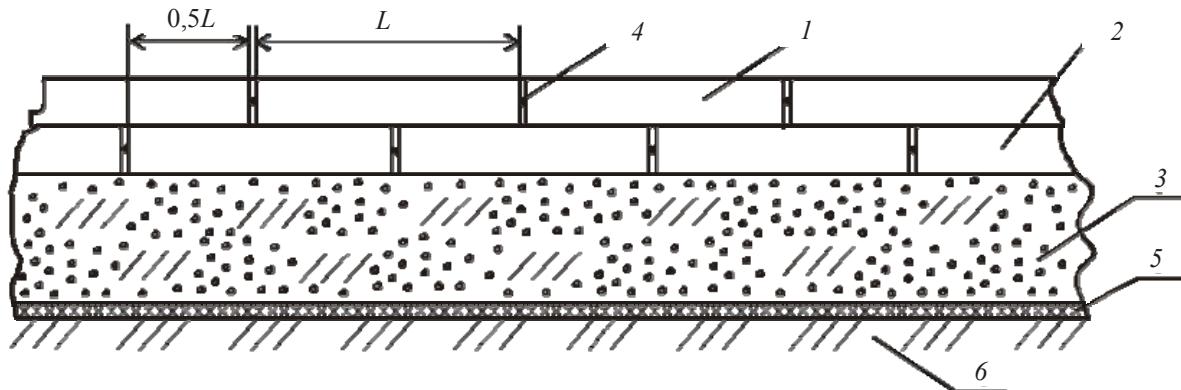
Двухслойное дорожное покрытие из железобетонных плит:
